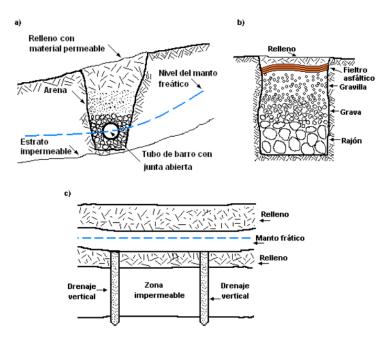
Distintos tipos de dren. a) tubo de barro. b) dren francés. c)dren vertical. (Martínez, 2014).
